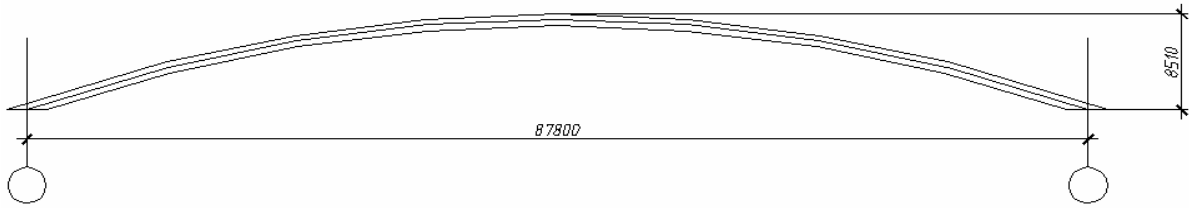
Геометрическая схема трубобетонной арки сплошного сечения А1.
